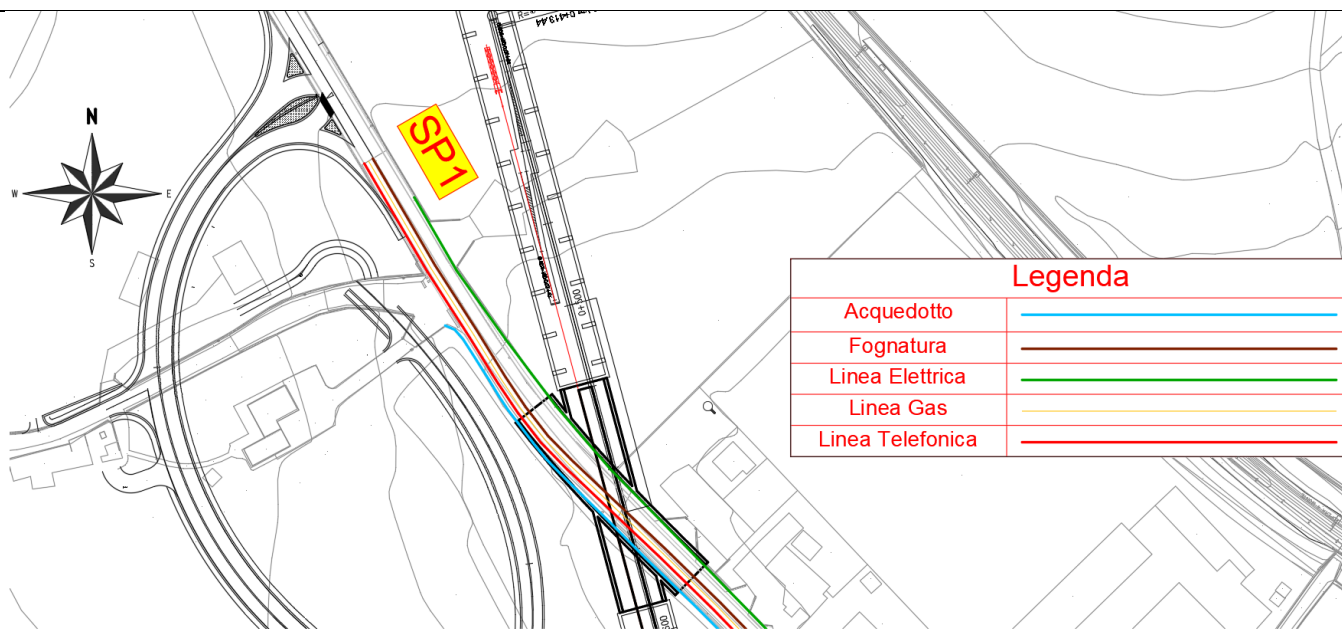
PPSS all' Intersezione Bypass -SP1 nella frazione di Brucoli
